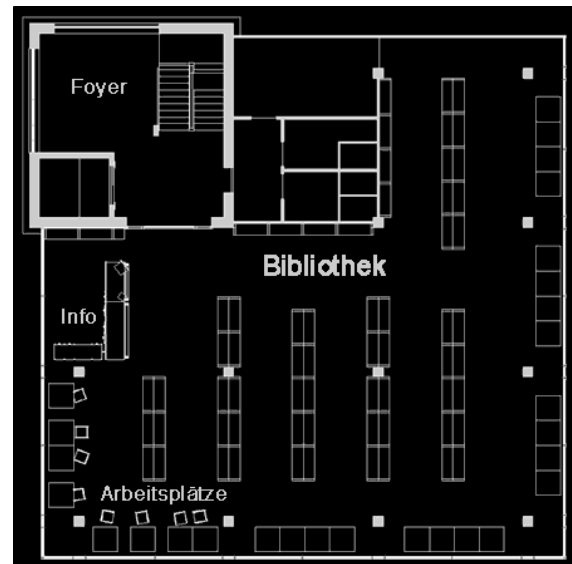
Grundriss Level 1: Bibliothek
